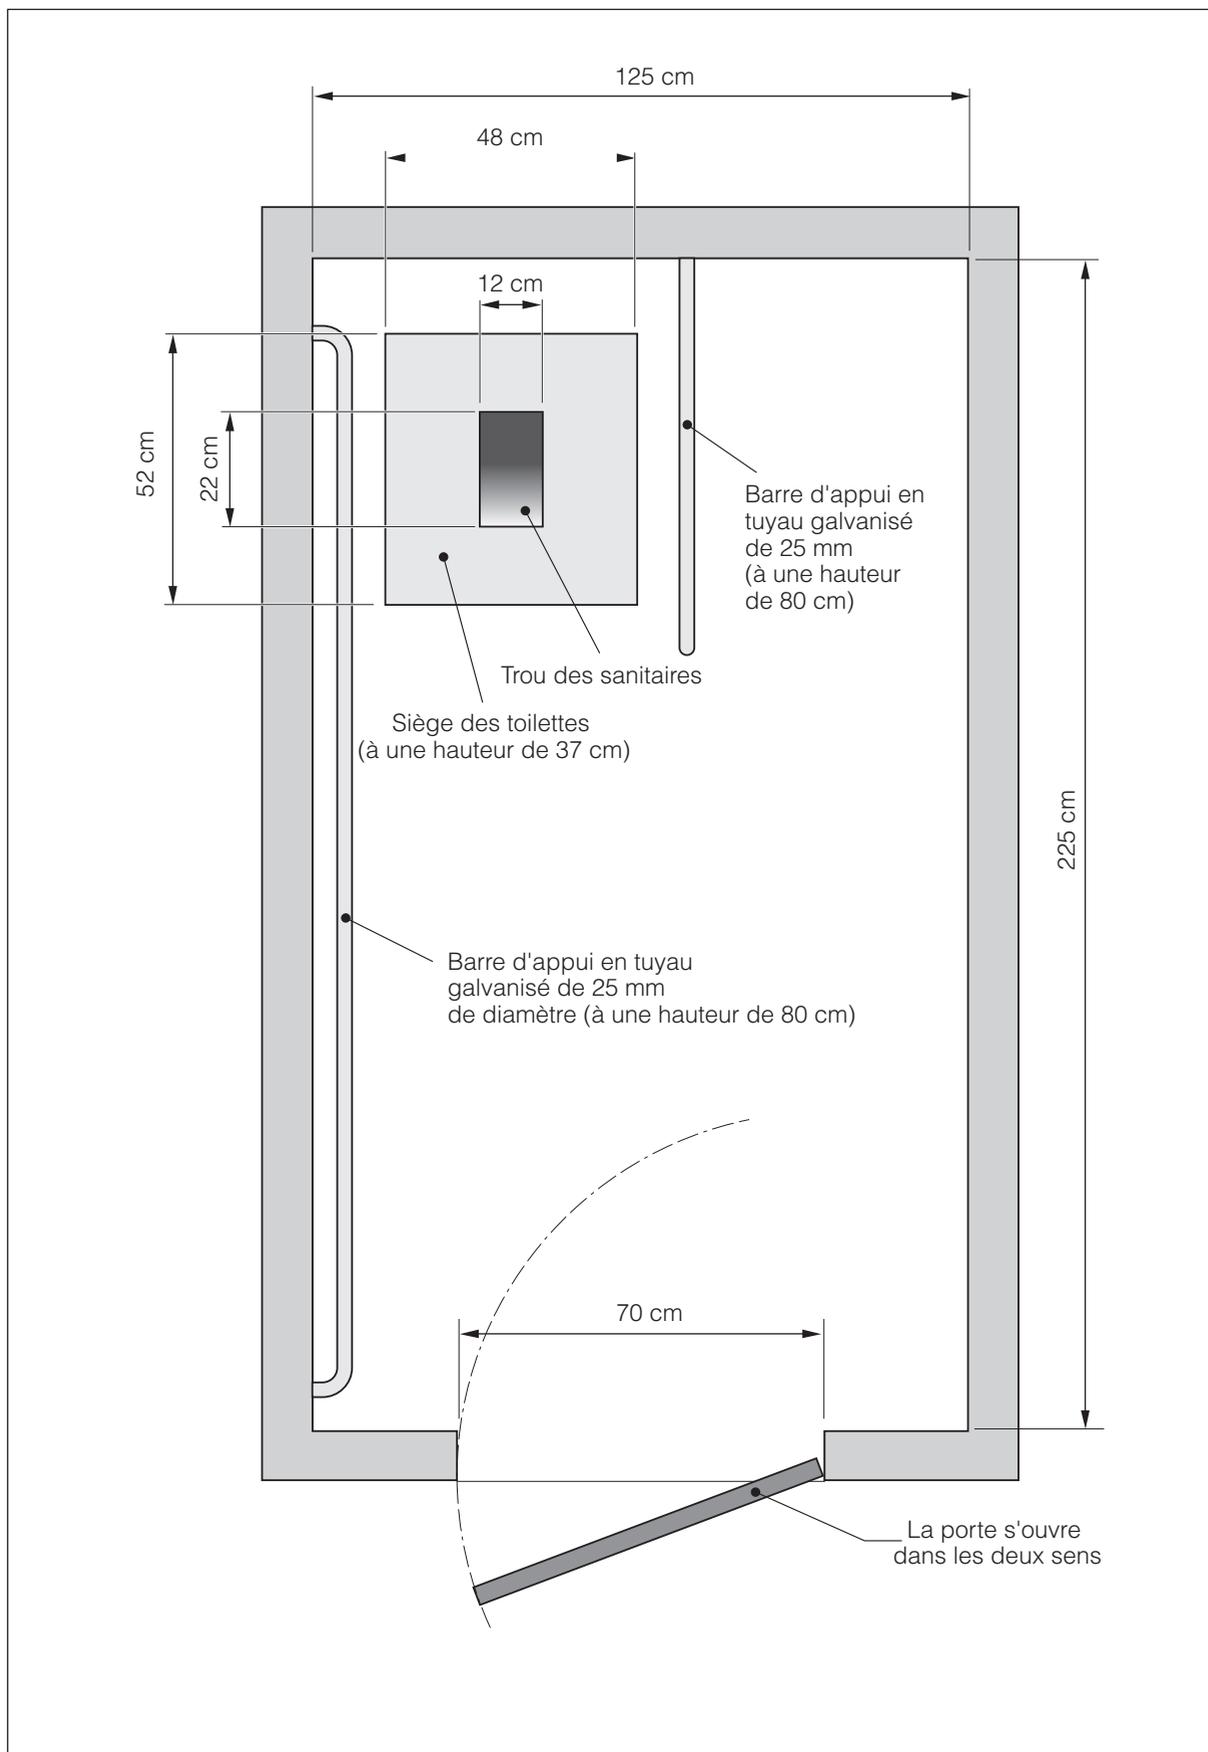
Le plan des sanitaires scolaires accessibles.
